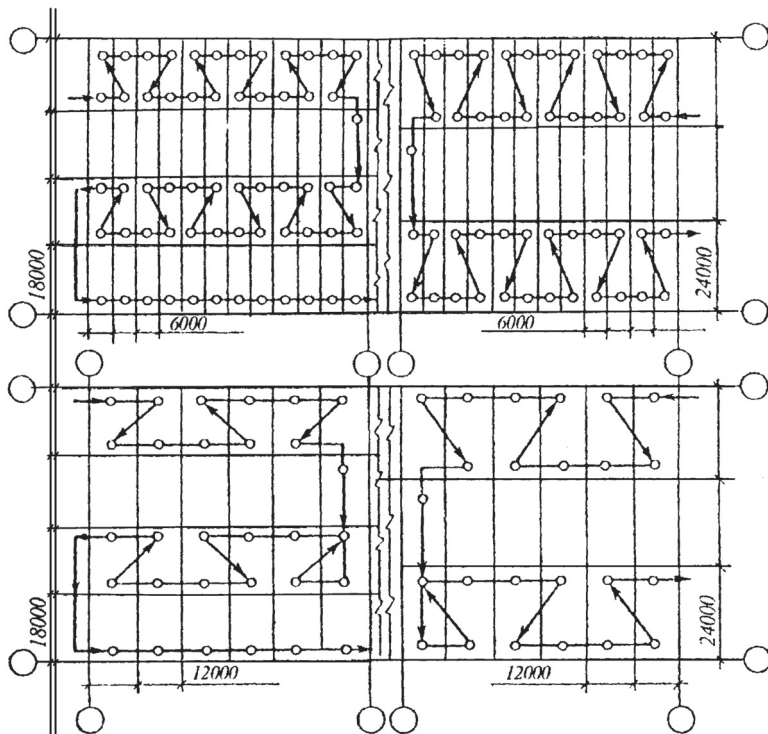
Схема движения крана при установке подкрановых балок пролетом 6 и 12 м
